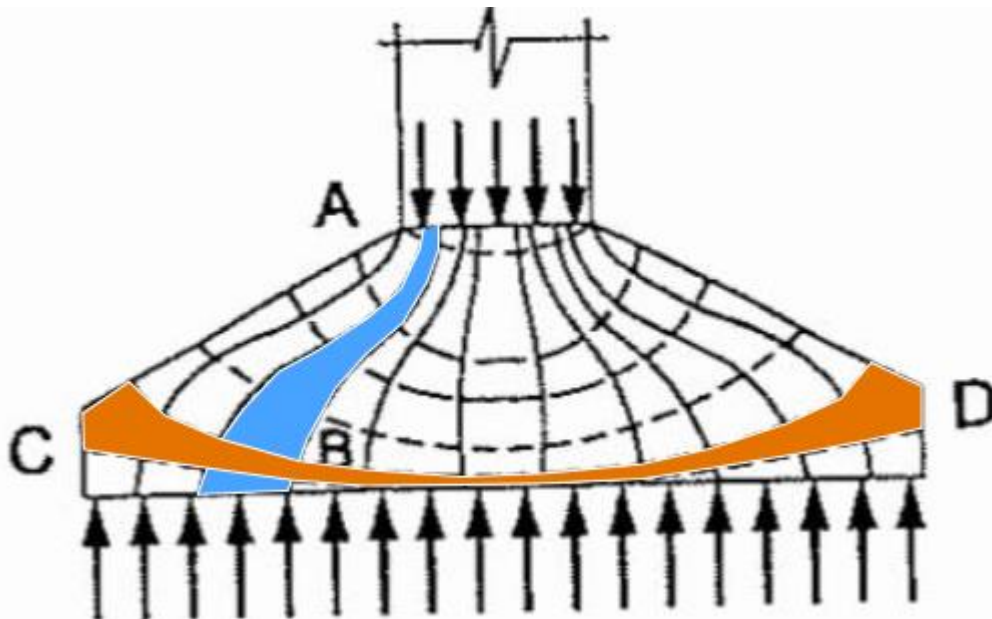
Distribución de esfuerzos de compresión y tracción en cimentación semirrígida.
